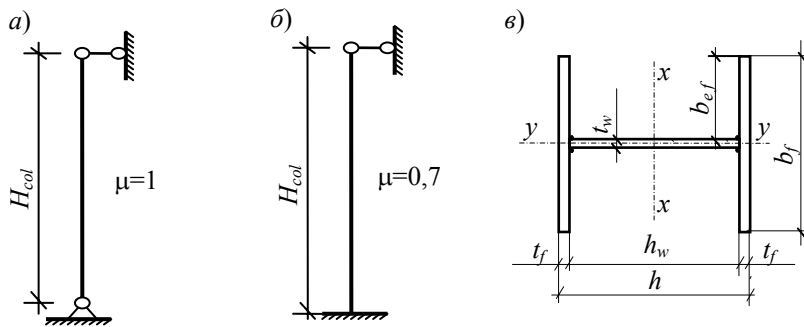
Расчетные схемы колонн (а, б); расчетное сечение сплошной колонны (в)
